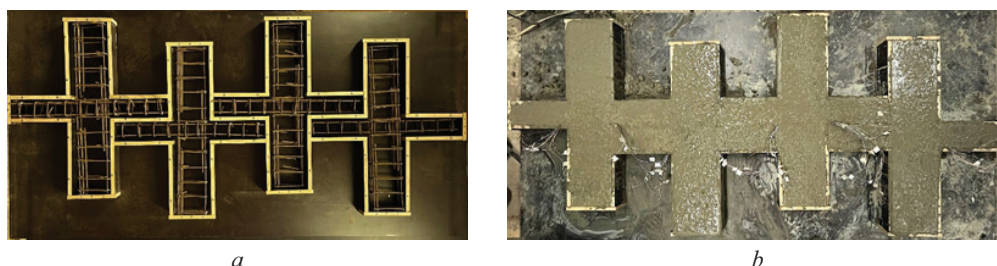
Опалубочные формы с установленными арматурными каркасами (а) и общий вид забетонированных опытных образцов (б)
